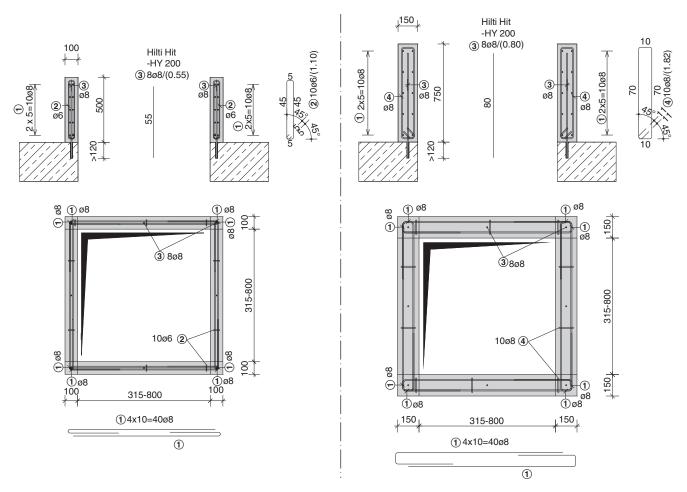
Bewehrungsplan Betonsockel Höhe ≤500 mm und ≤750 mm
